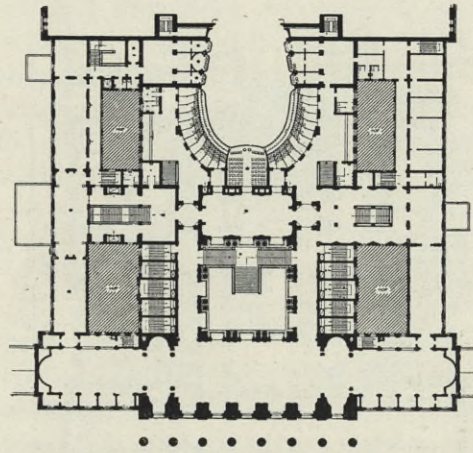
Grundriß des Zuschauerhauses in Höhe des I. Rang.
